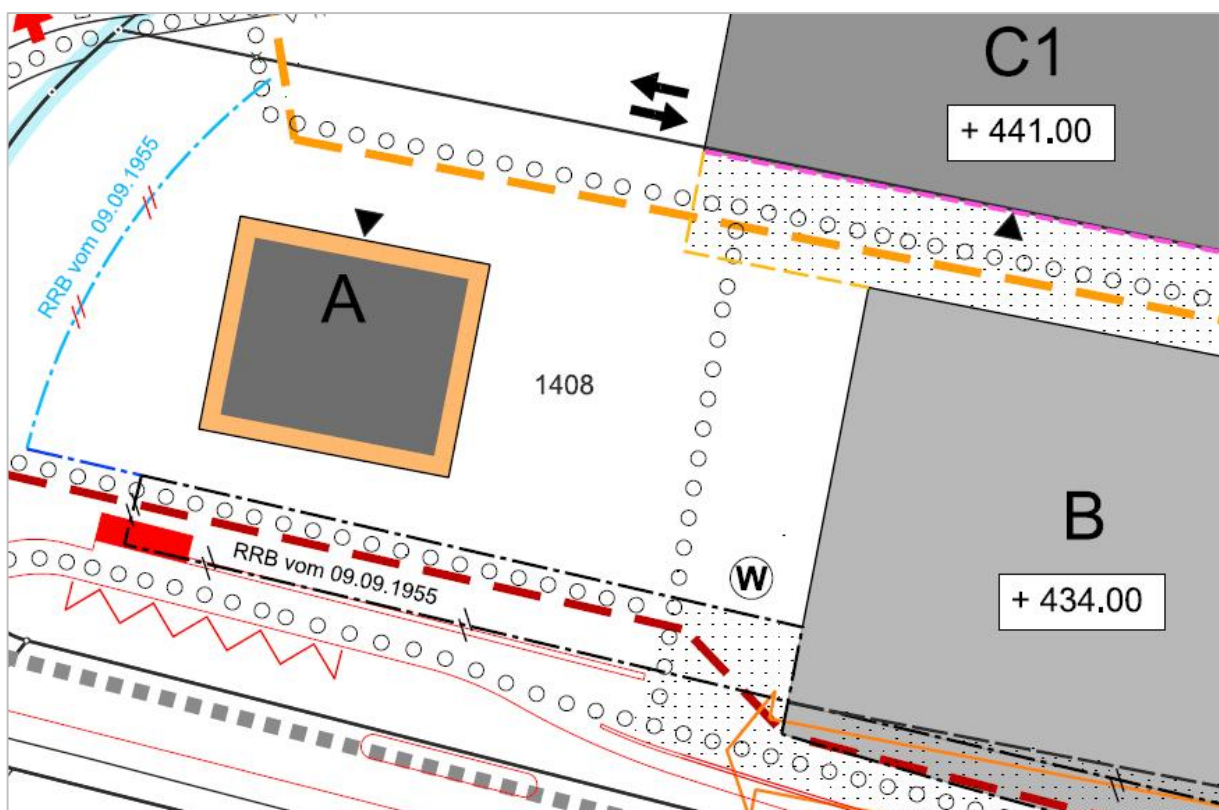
Ausschnitt Baulinien aus Bebauungsplan, ohne Massstab
